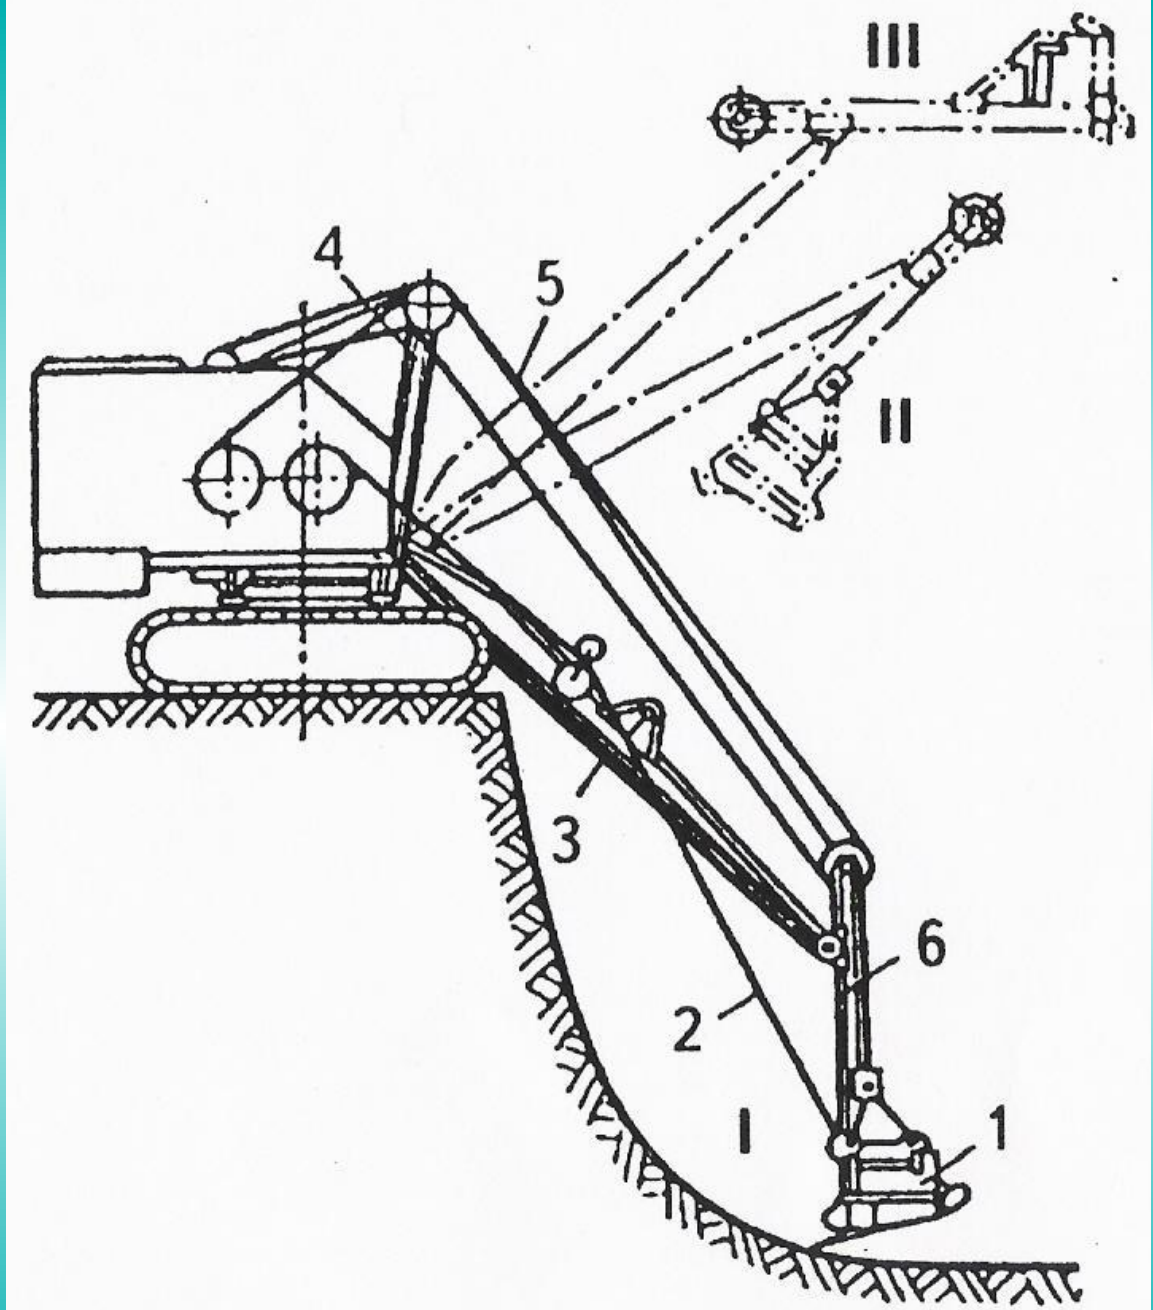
Обратная лопата: 1 – ковш; 2 – тяговый канат; 3 – стрела; 4 – двуногая стойка; 5 – подъемный канат; 6 - рукоять
